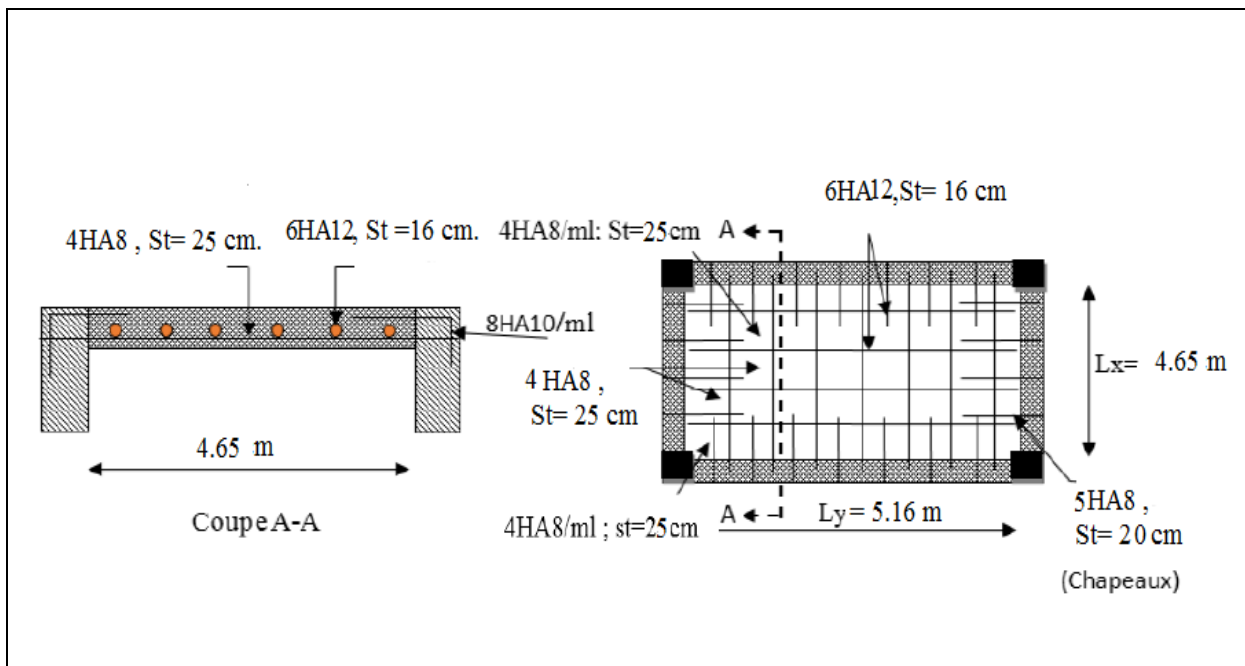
Schéma de ferrailage de la dalle sur 4 appuis (RDC)
